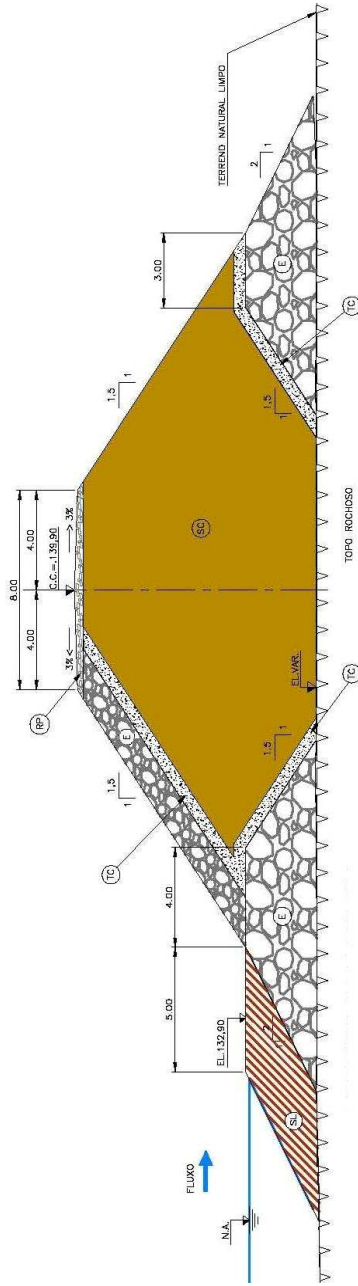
Ensecadeira de montante 2ª Fase - seção tipo 1- aterro dentro do arroio (trecho 2)
